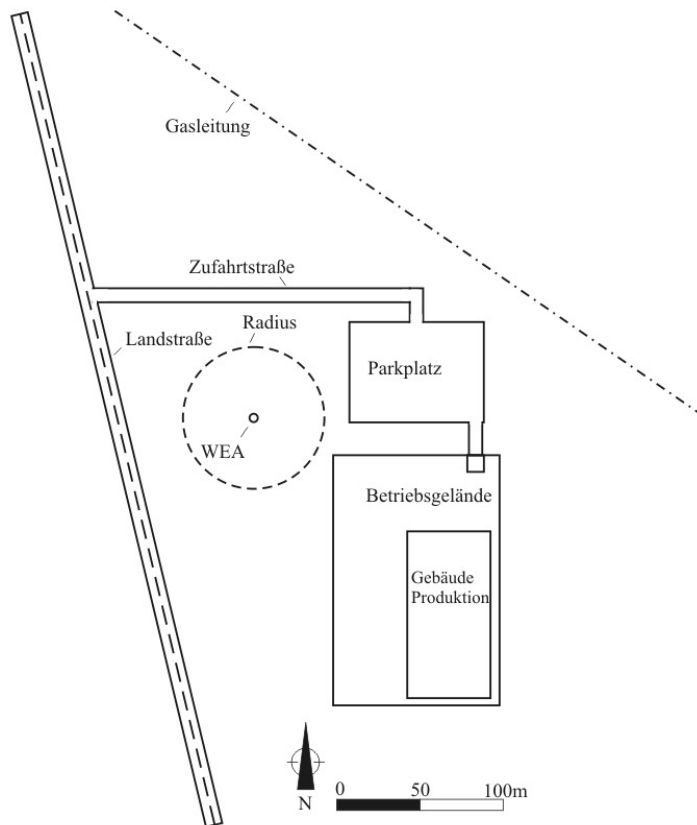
Lageplan des Standorts Schönbetrieb (Hauschild et al. 2014)
